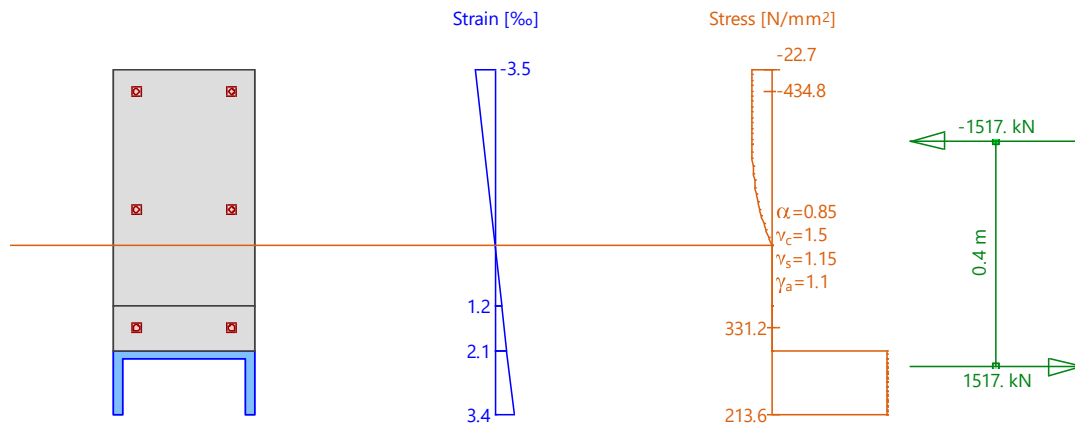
Diagrama tensional en rotura para la viga reforzada.
